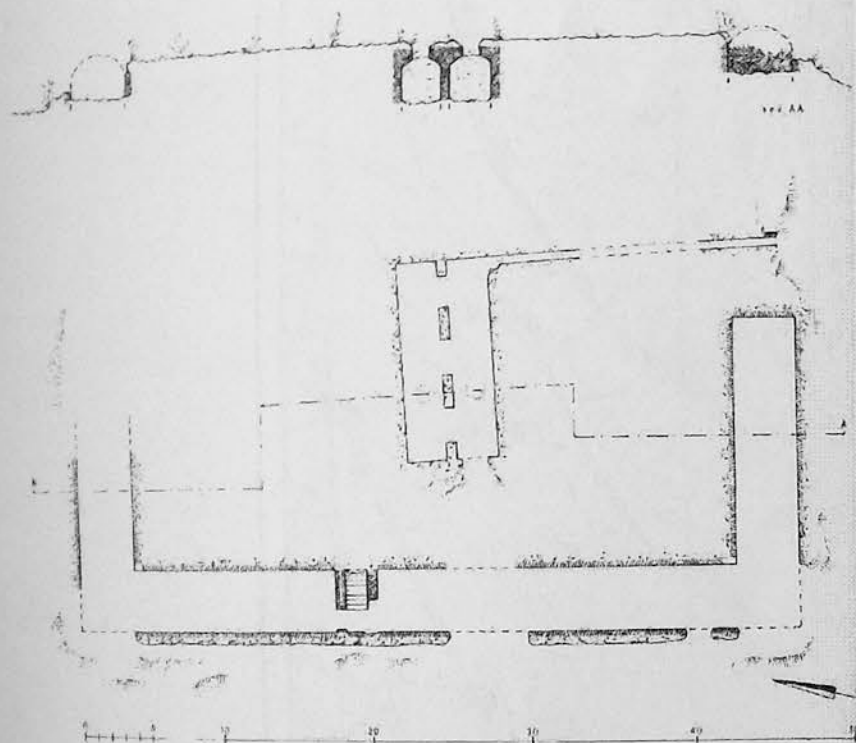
Grottaglie: villa, pianta e sezione (n. 40)
